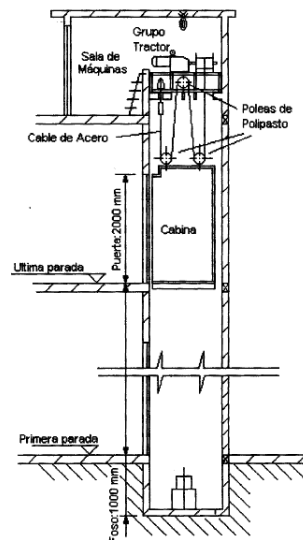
Esquema de partes del sistema por enrollamiento de cable
